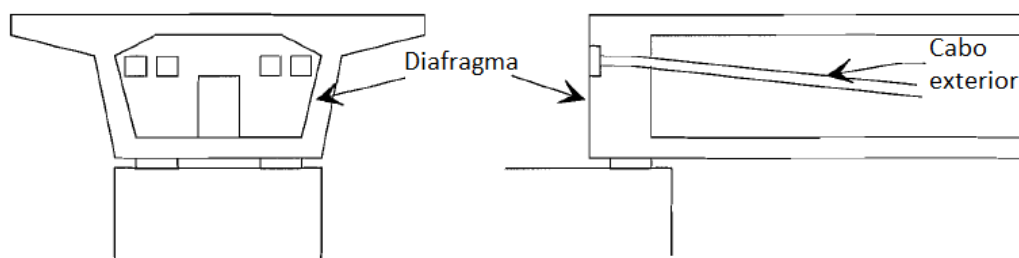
Aduela sobre pilar com dispositivo de ancoragem
